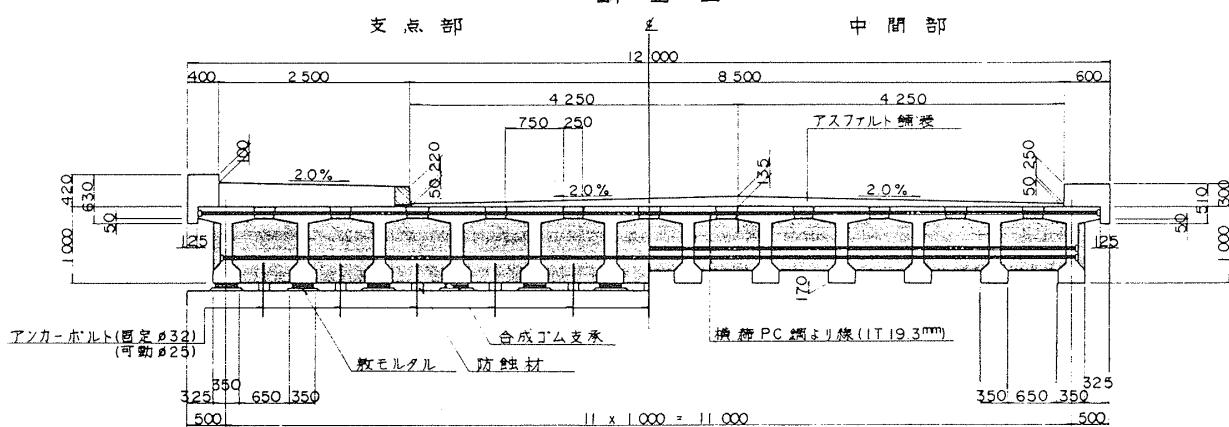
プレテンション方式PC-T桁橋設計例³²⁾
